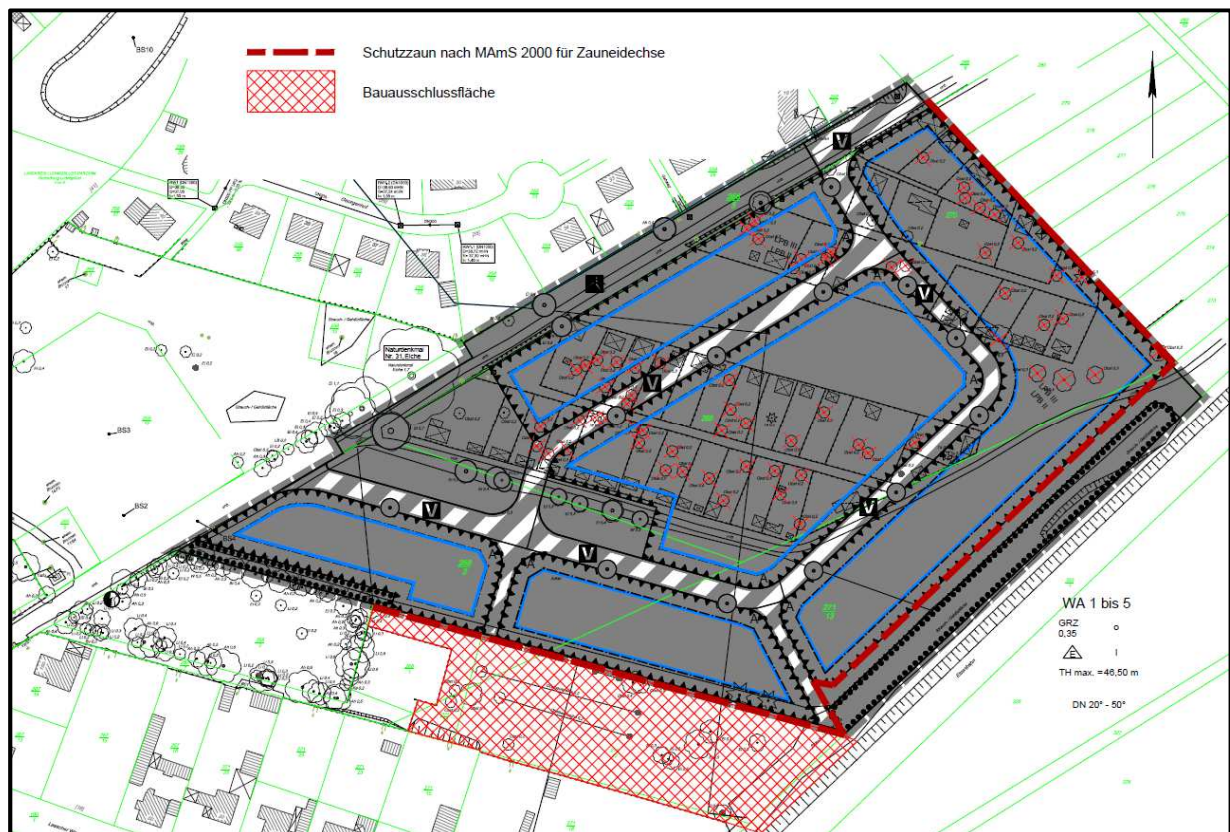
Lage Schutzzaun für Zauneidechse und Bauausschlussflächen
